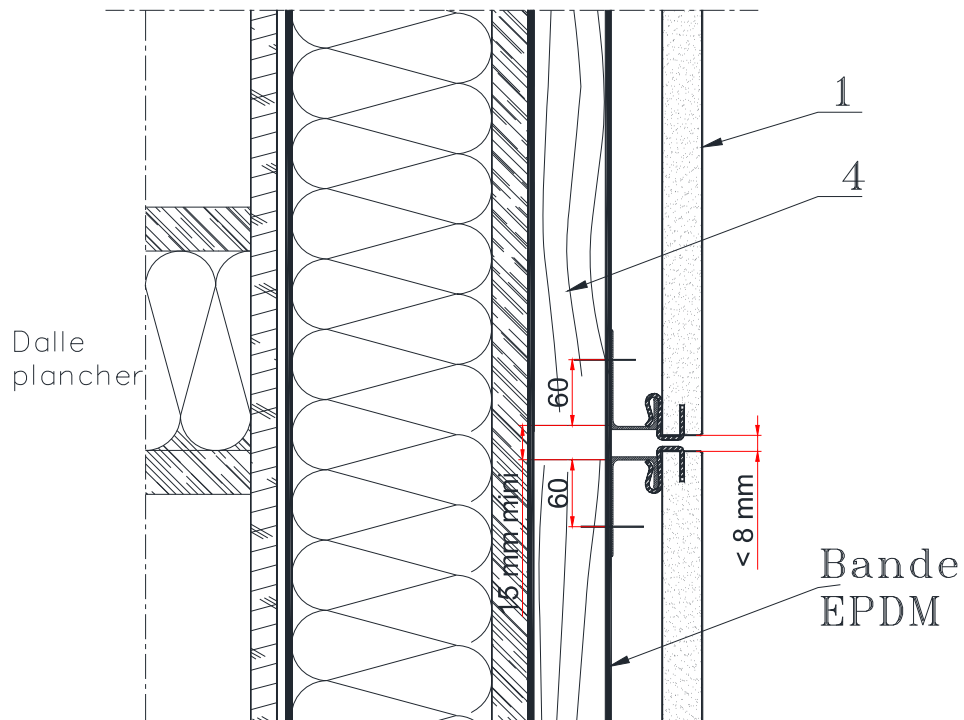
Principe de montage coupe verticale (joint horizontal)
